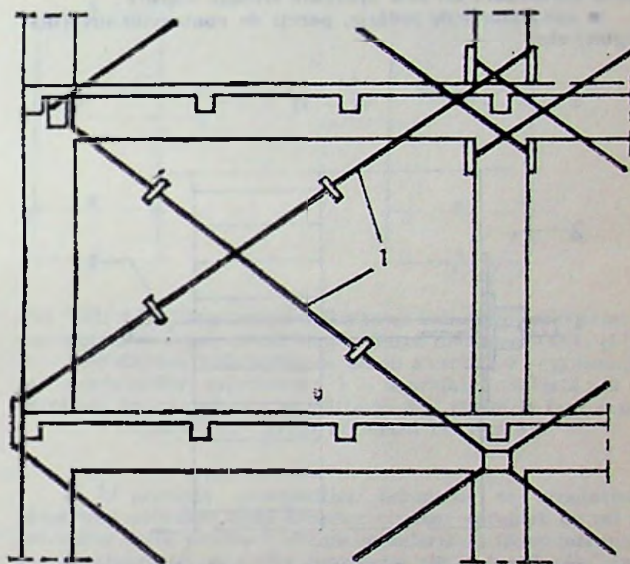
Consolidarea structurilor de beton armat cu elemente suplimentare din tiranți metalici. (după N. Ignatiev, Sofia [11].
